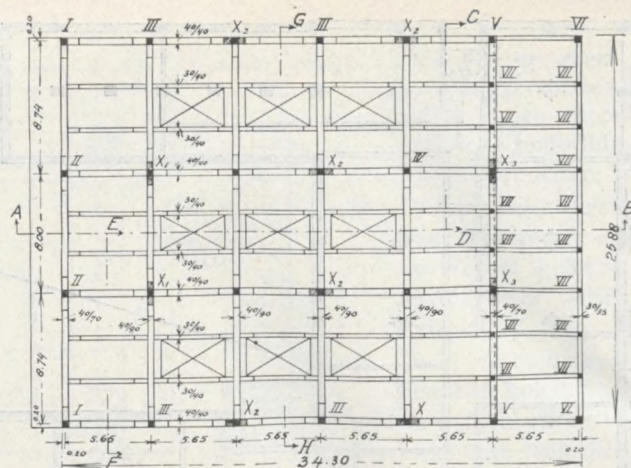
Gewapend beton winkelgebouw te San José, Costa Rica. Plattegrond 1:500.
